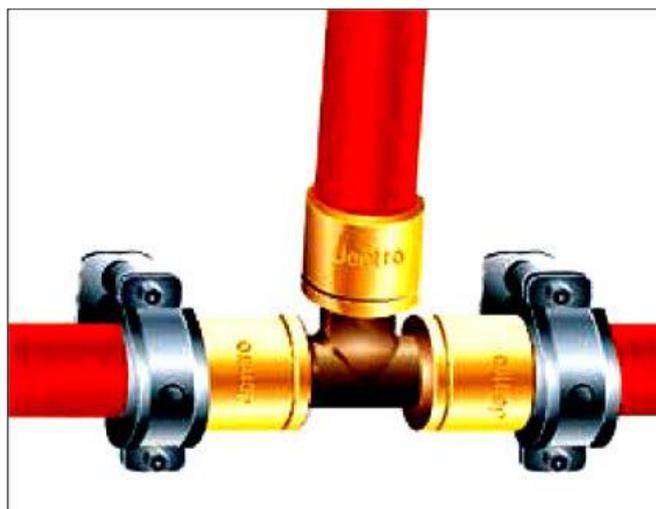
Устройство неподвижных опор на трубопроводах из сшитого полиэтилена
